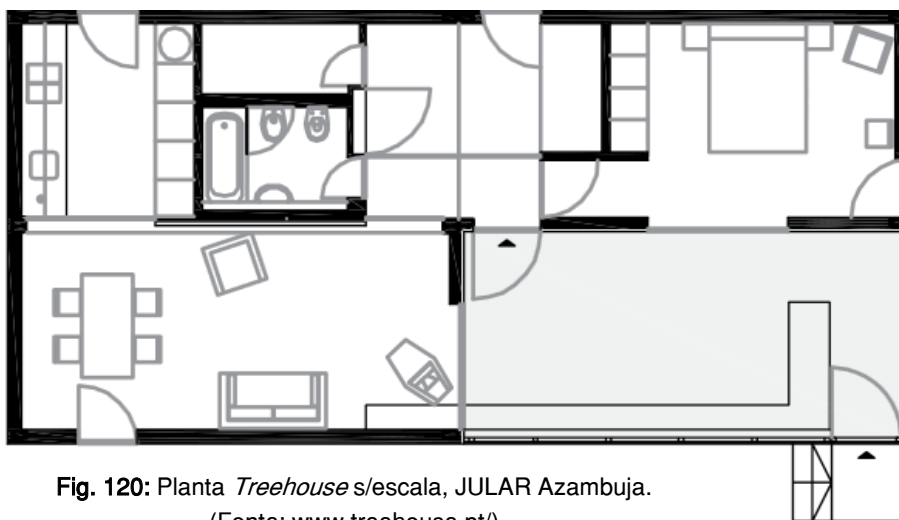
Planta *Treehouse* s/escala, JULAR Azambuja.
